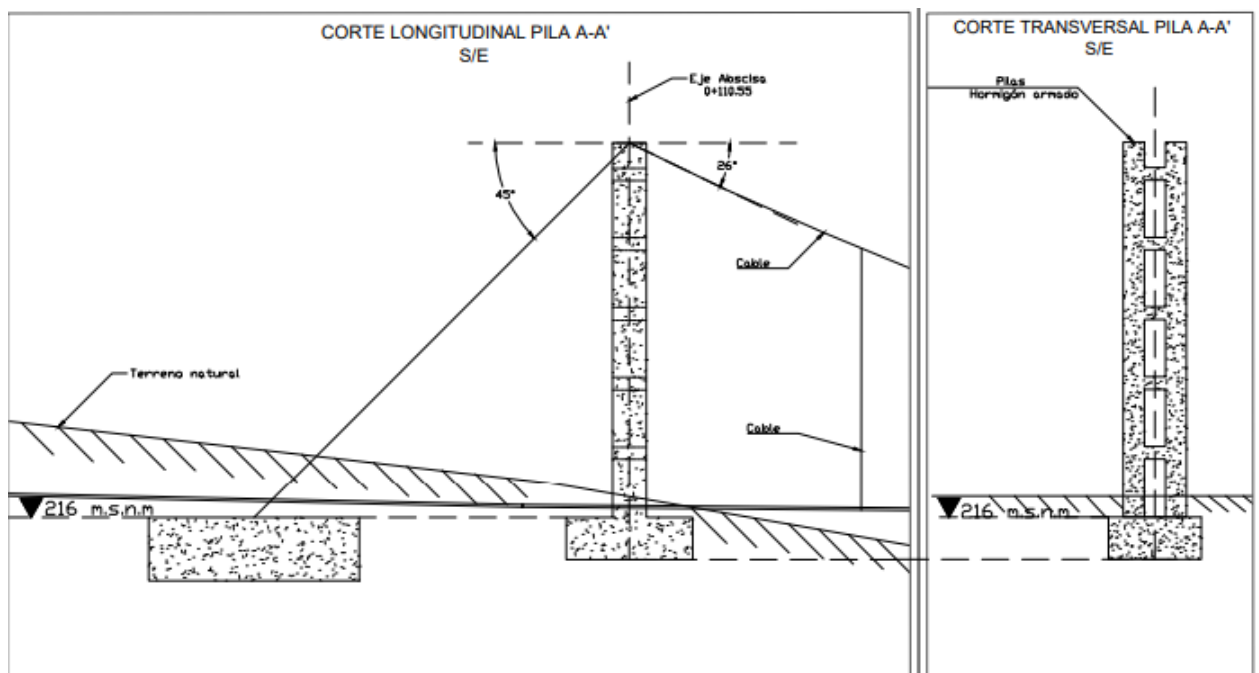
Vista longitudinal y lateral para pila A-A'.
